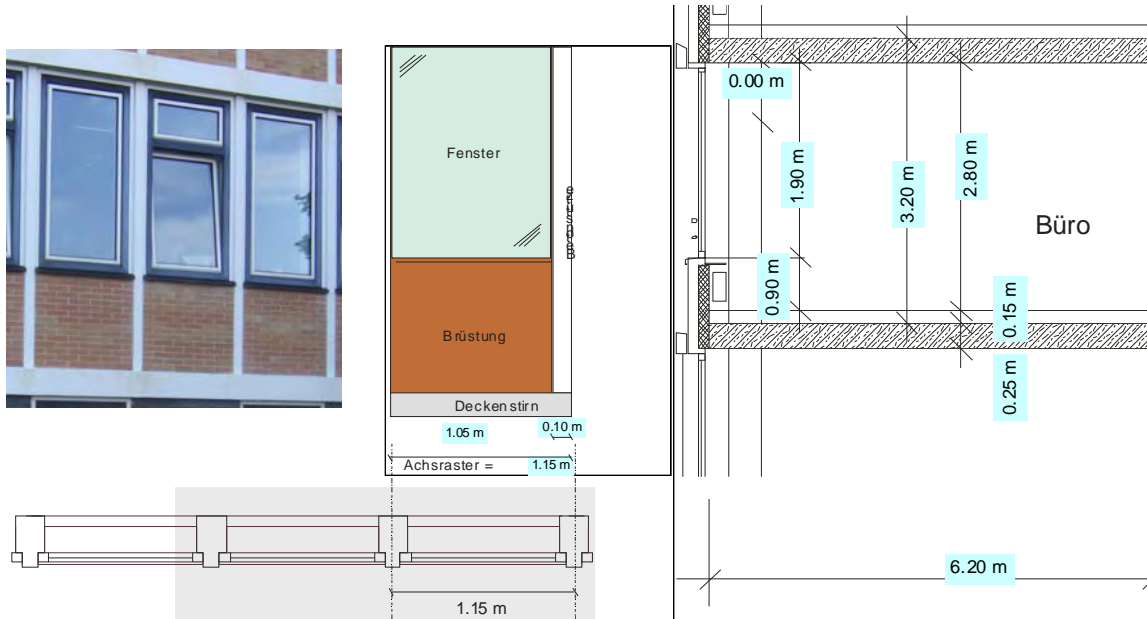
Schematische Fassadenansicht, Fassadenraster und Schnitt Büroraum
